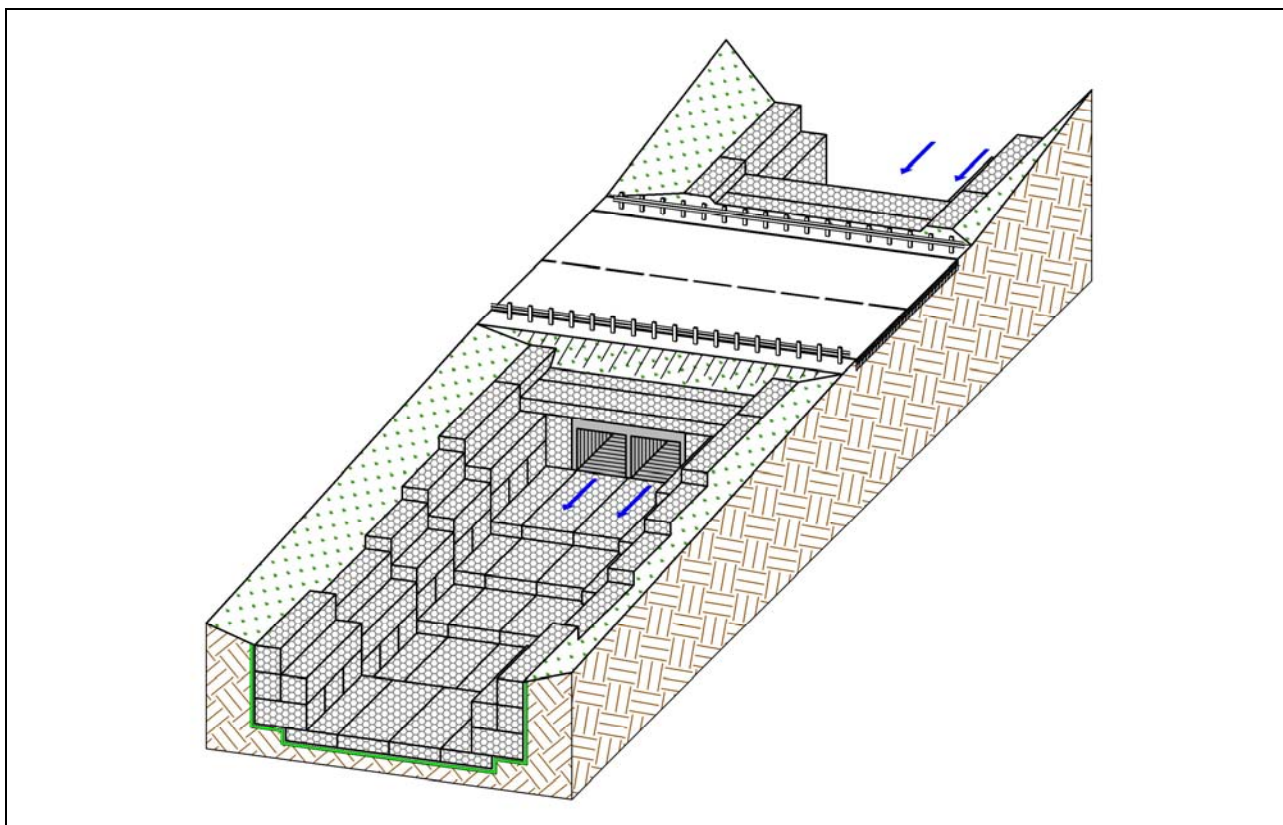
(продолжение) Укрепление оголовков водопропускной трубы с устройством водобойных колодцев из габрионных конструкций
